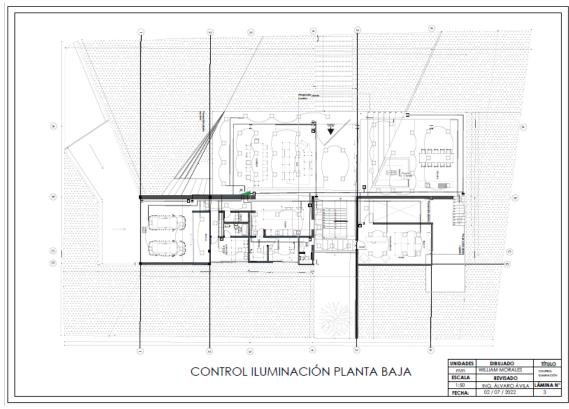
Plano del diseño de control de iluminación con Loxone planta baja.
